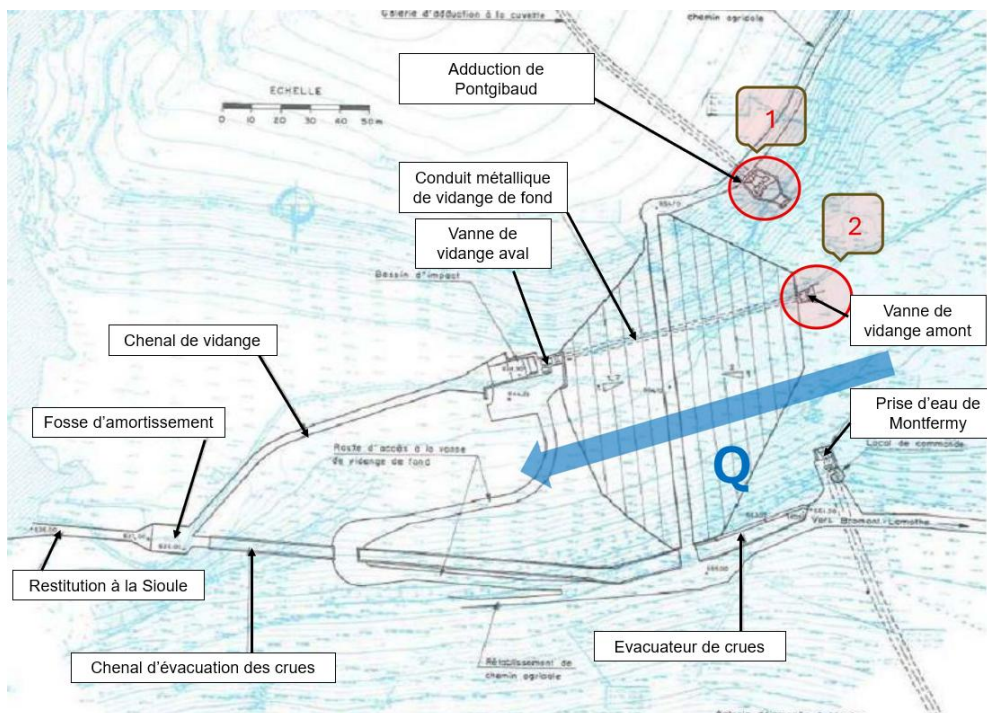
Barrage d'Anchal – vue en plan (Source : EDF)
